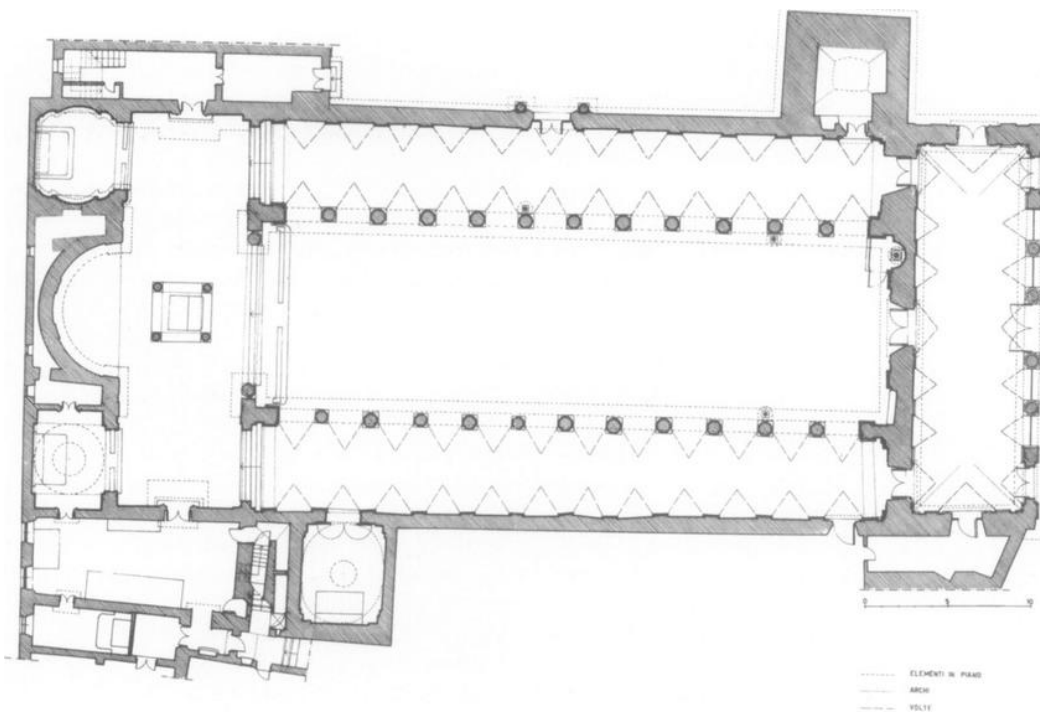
Grundriss San Crisogono im heutigen Zustand mit späteren Zubauten, 1123 – 1129, Rom.
